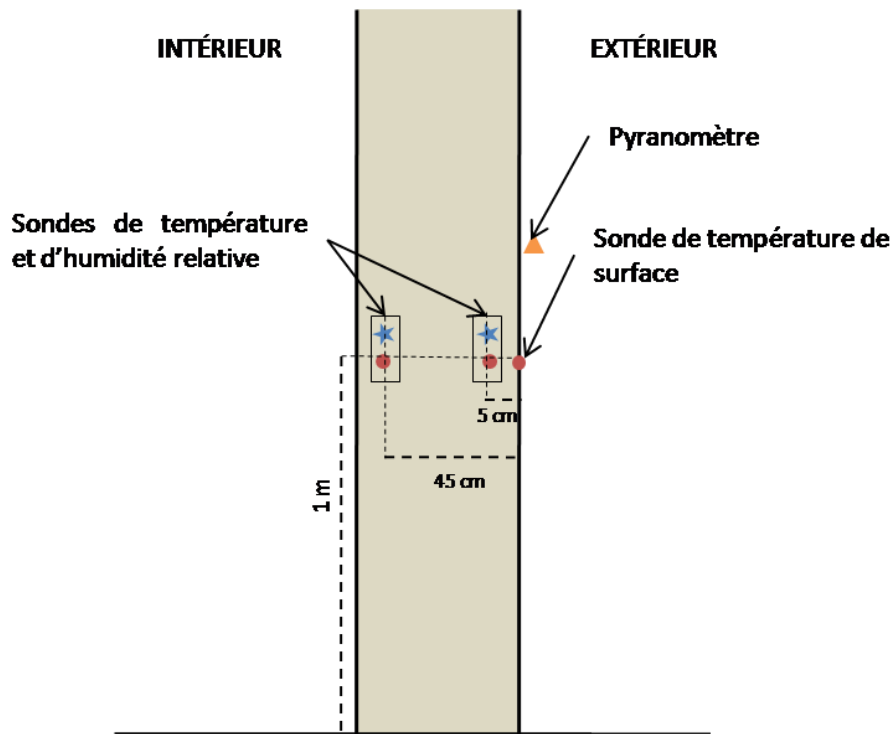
Plan de l'instrumentation de la paroi Sud au droit du séjour
